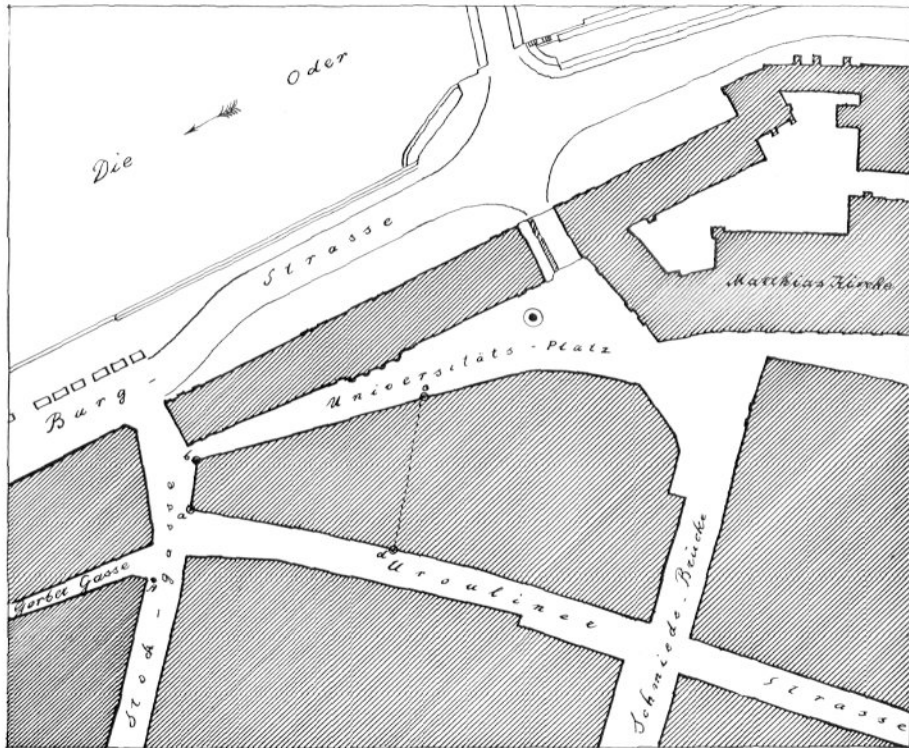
Lageplan der gegenwärtigen Bebauung
